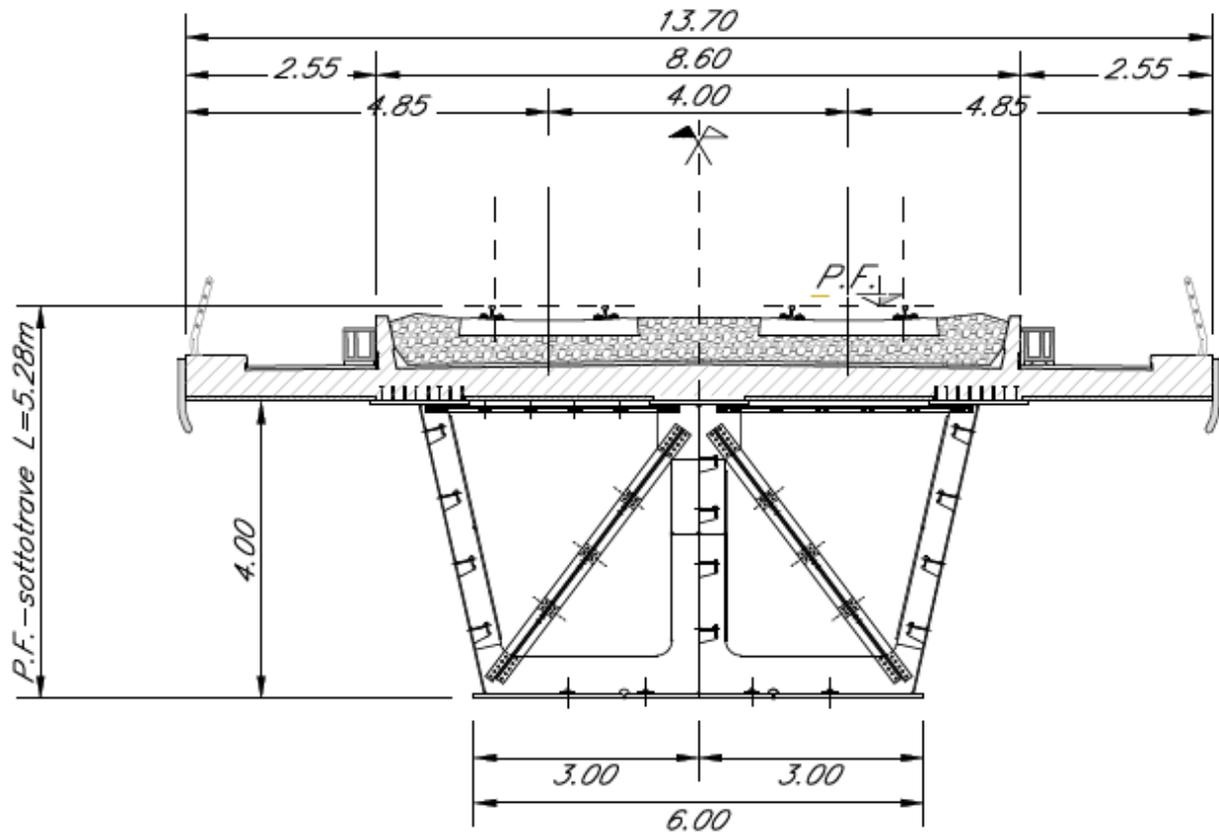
sezione trasversale dell'impalcato misto acc-clc 60m
